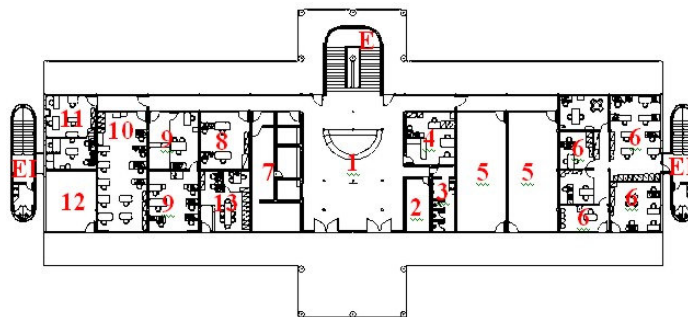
Prefeitura Municipal de Mariana – Pavimento Térreo – Planta Baixa.
